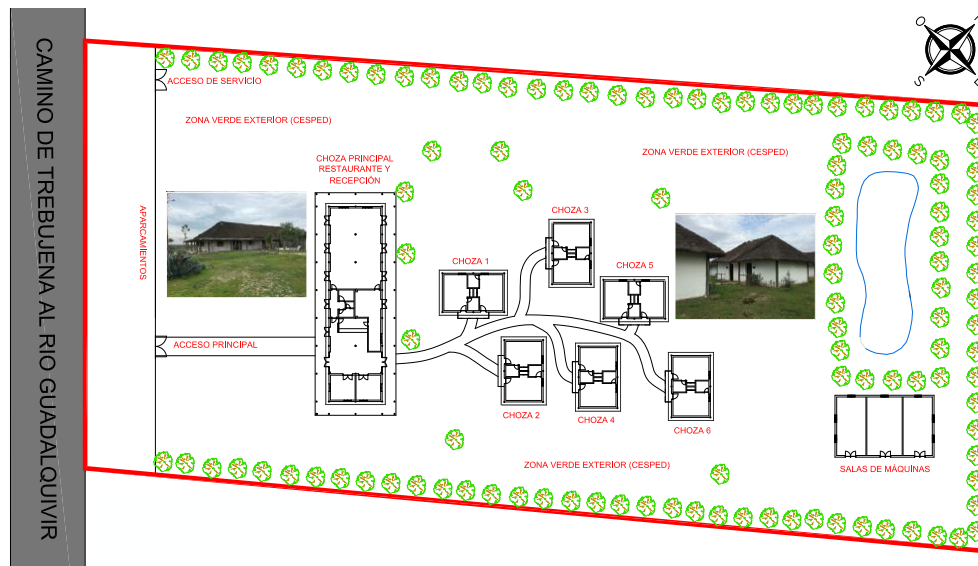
Plano de Distribución de Chozas Marismeñas..
